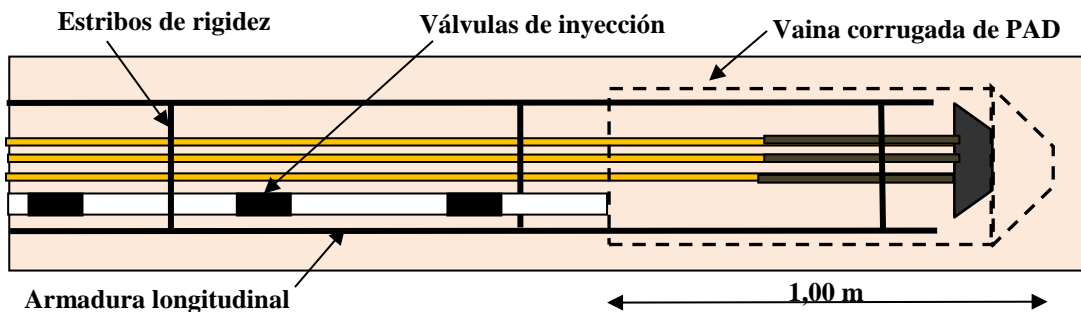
Esquema de la armadura del anclaje en la punta y en la zona de bulbo
